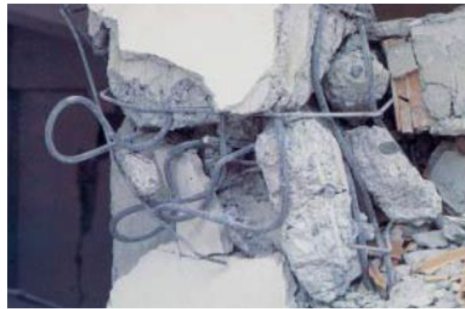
Pilar de betão armado com inadequada armadura de esforço transverso [9]
